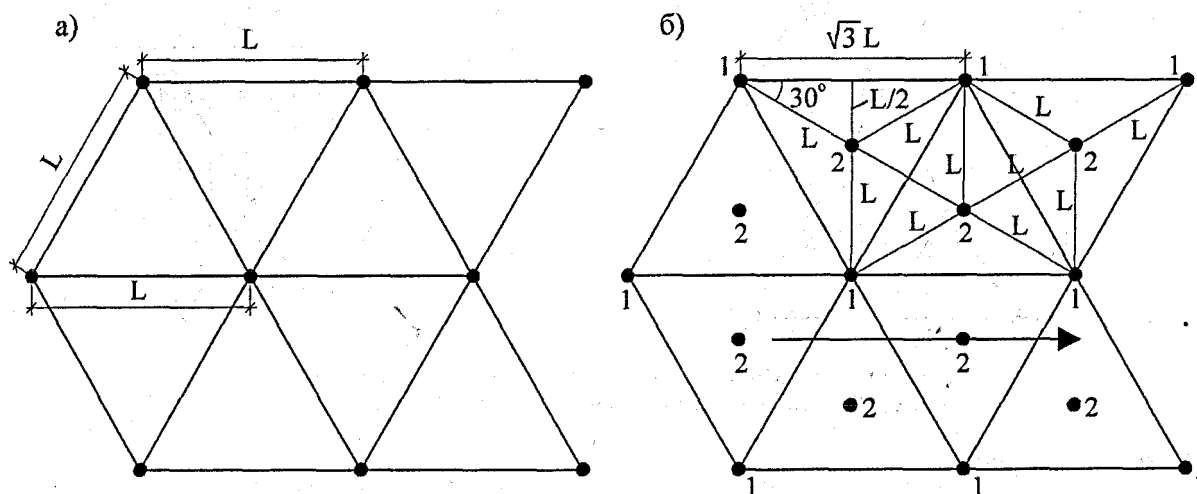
Схемы уплотнения грунтов: а – одноэтапная; б – двухэтапная
